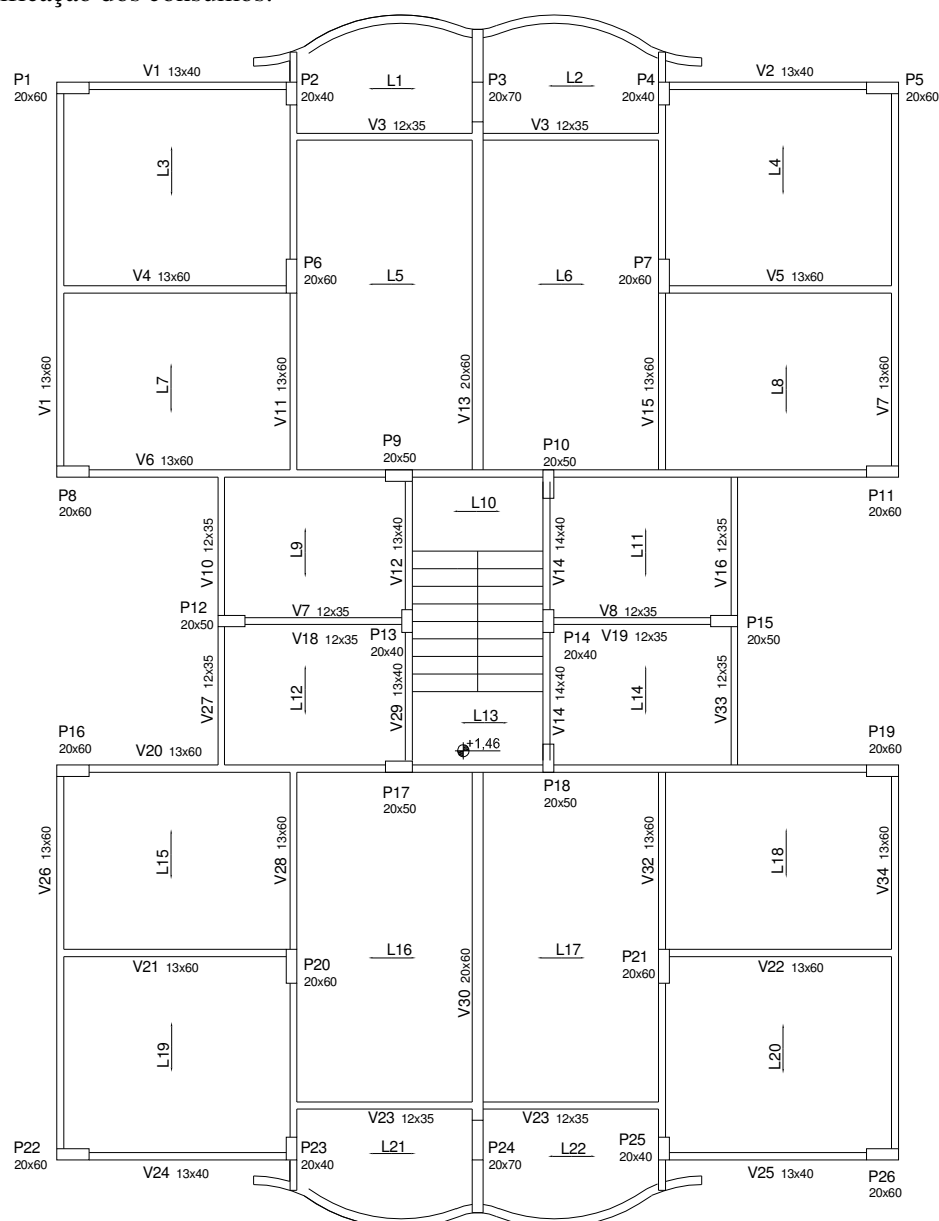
Planta de forma do pavimento tipo para estrutura convencional em concreto armado
